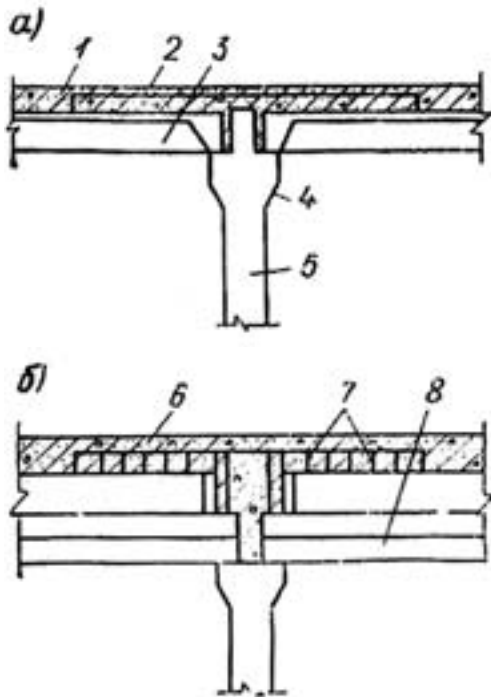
Установлення надпорної арматури у збірно-монолітному перекритті сховища:
